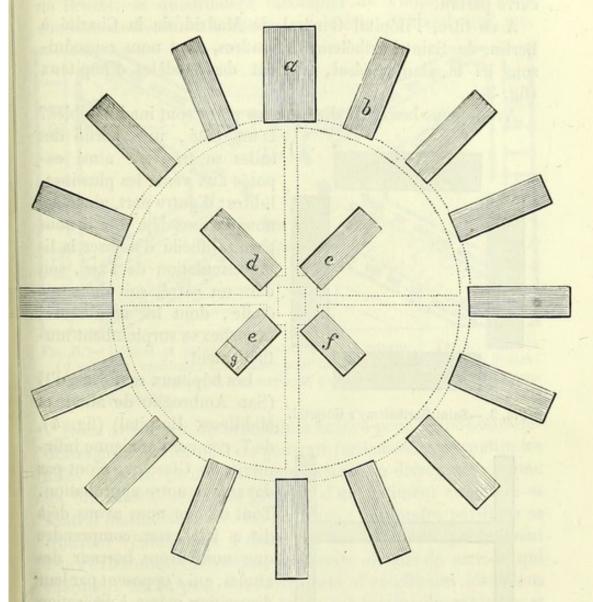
Hammond general Hospital. Plan du rez-de-chaussée : a, bureaux de la direction; b, salles de malades; c, cuisine; d, lingerie; e, maison de garde; f, knapsack room; g, chambre des morts.
